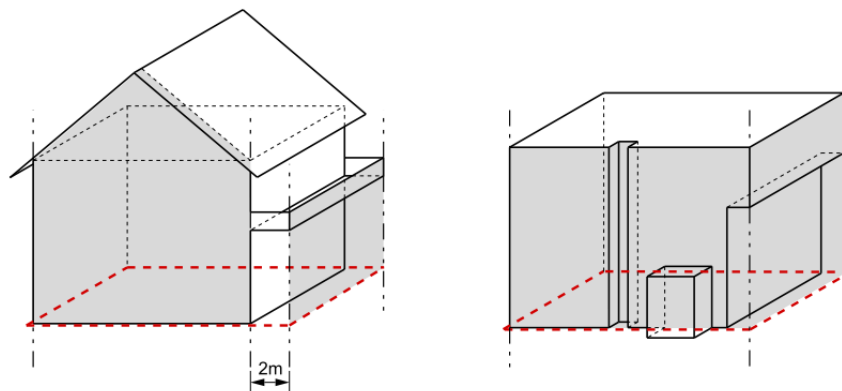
Fassadenflucht und Fassadenlinie (§ 40 und § 41)
